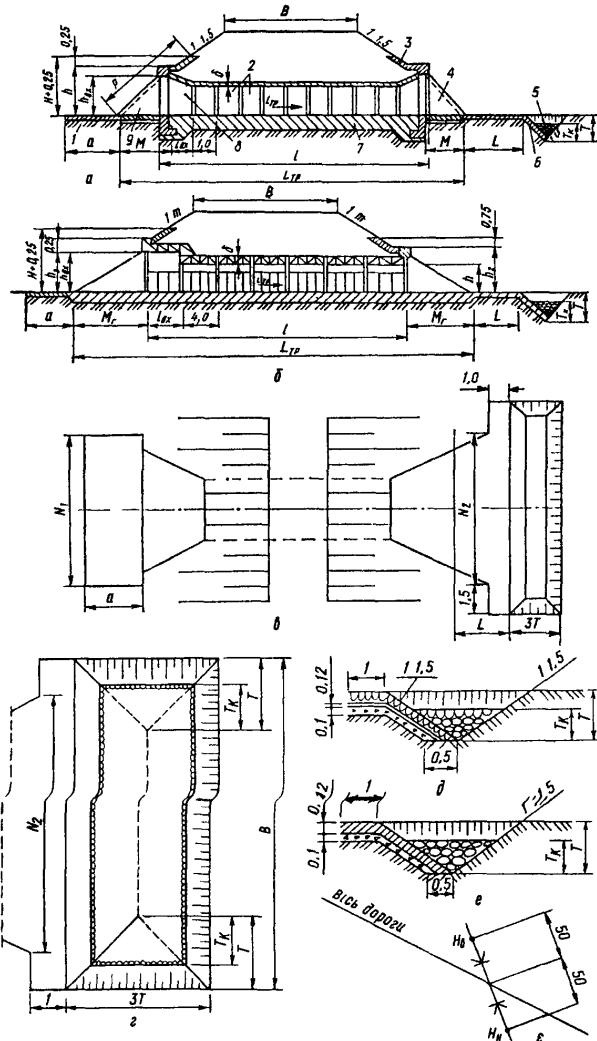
Укріплення русел і укосів біля водоперепускних труб (розміри в м).
